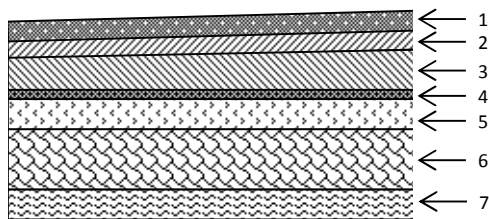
coupe verticale d'un plancher terrasse inaccessible
